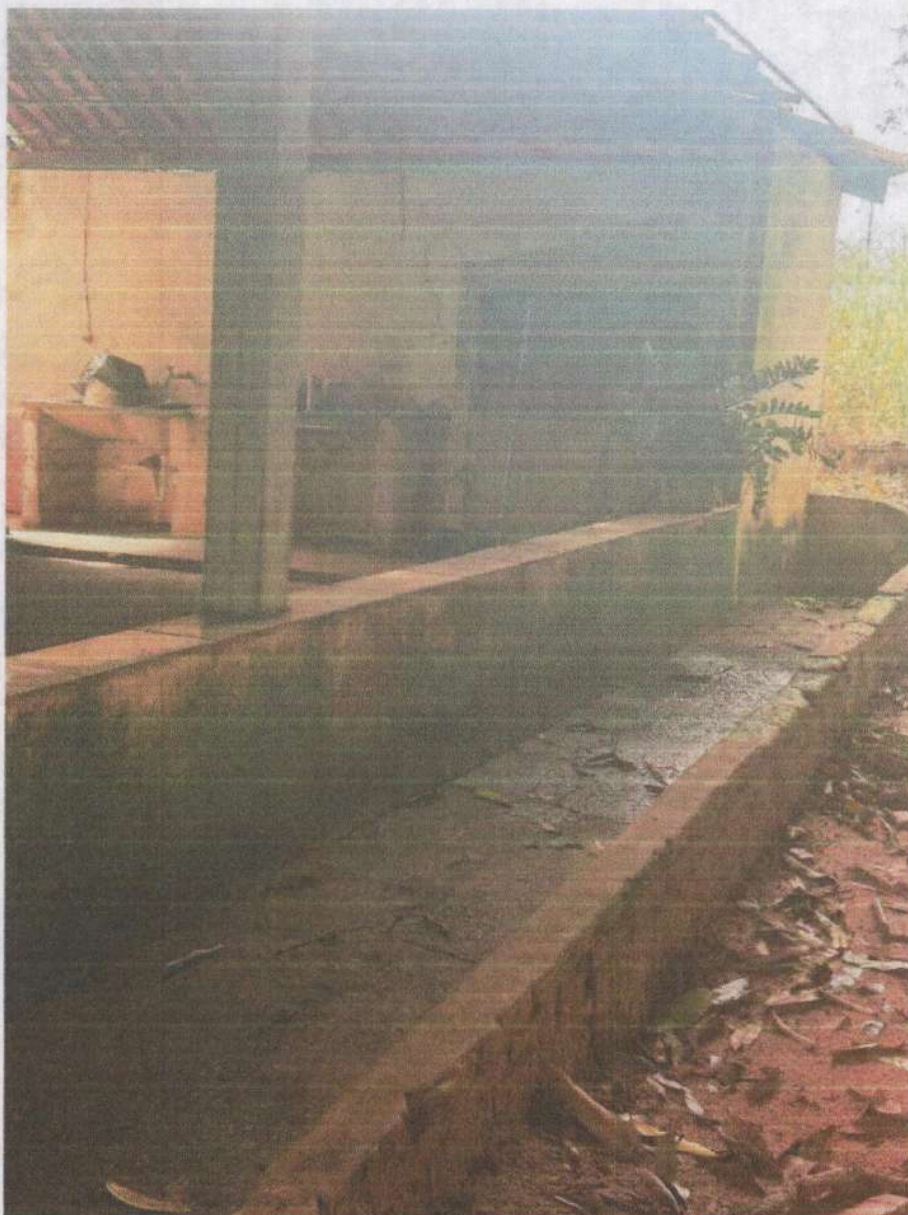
Desníveis, patologias de infiltração, mofo e telhado danificado.
